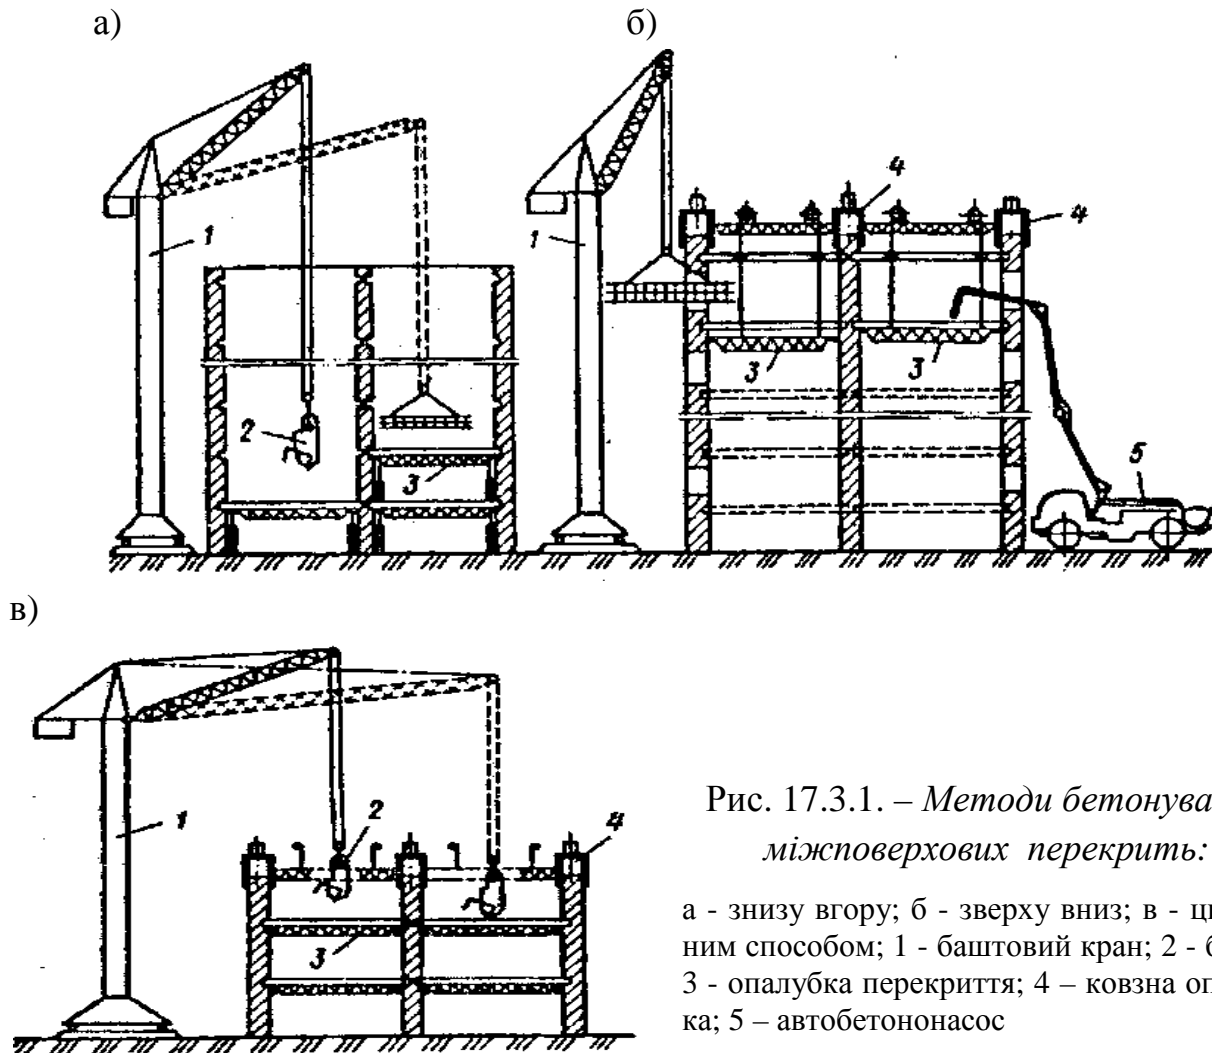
Методи бетонування міжповерхових перекриттів:
